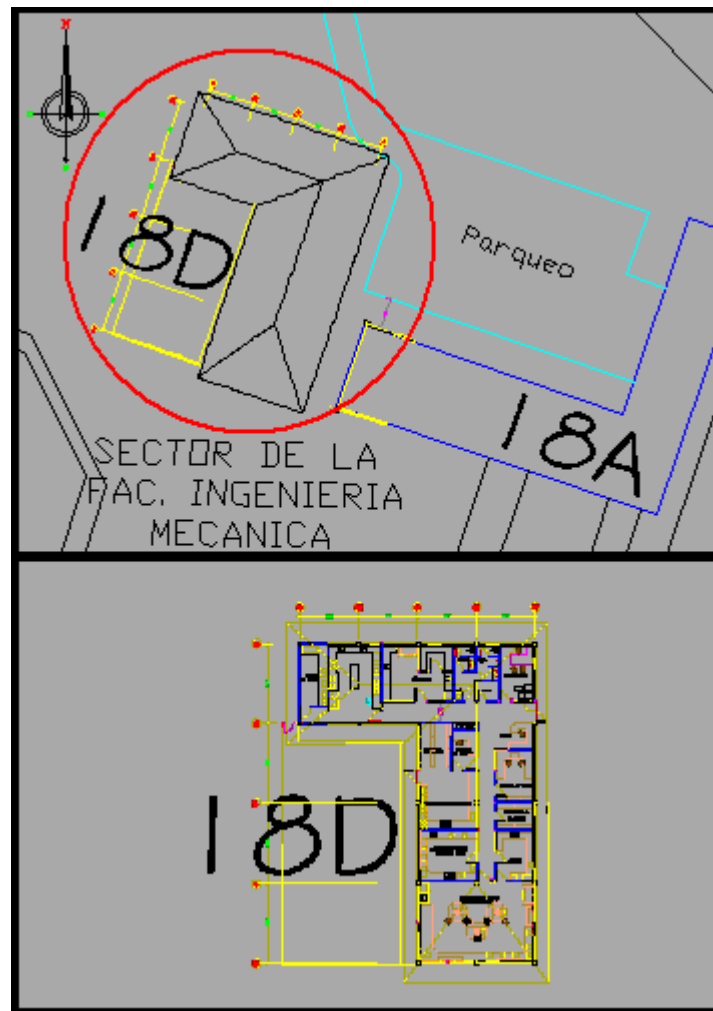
IMPLANTACIÓN DEL EDIFICIO 18D EN EL SECTOR DE FIMCP, PLANTA ARQUITECTÓNICA EDIFICIO 18 D
